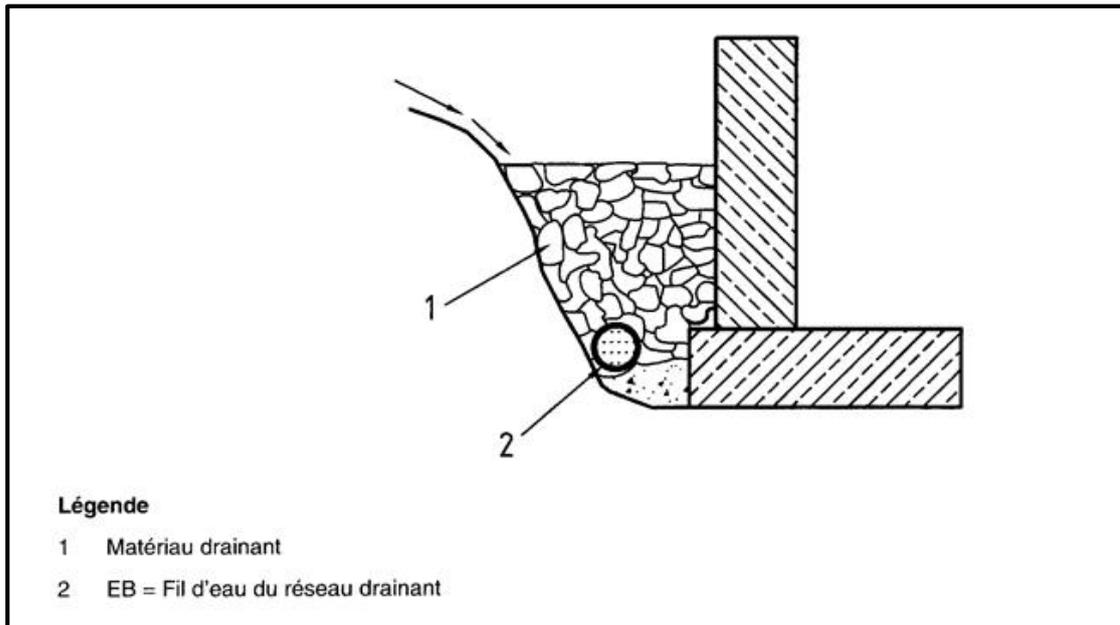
Exemple de cas d'eaux de ruissellement ou d'infiltration avec drainage sans revêtement
